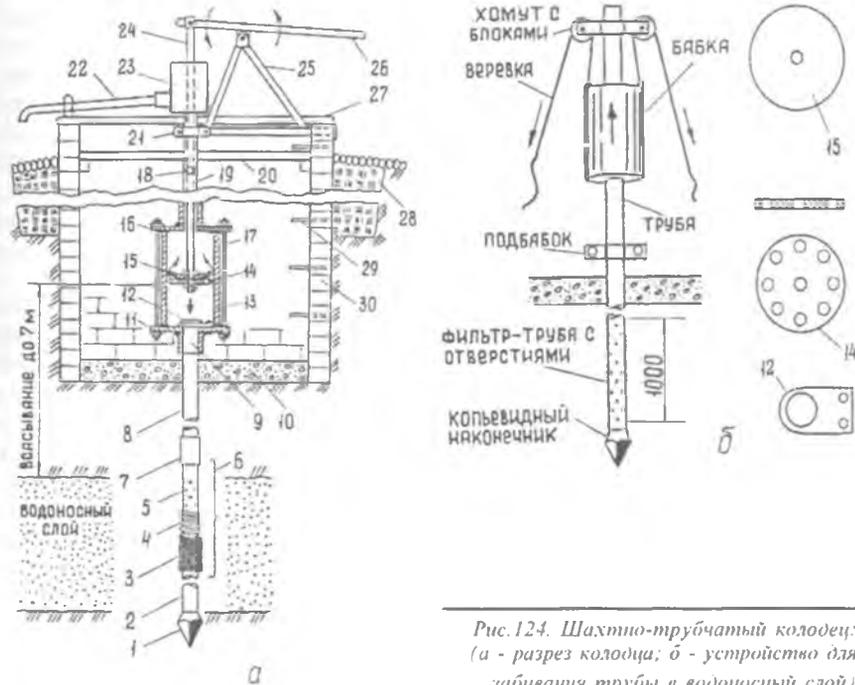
Шахтно-трубчатый колодец: (а - разрез колодца; б - устройство для забивания трубы в водоносный слой)
